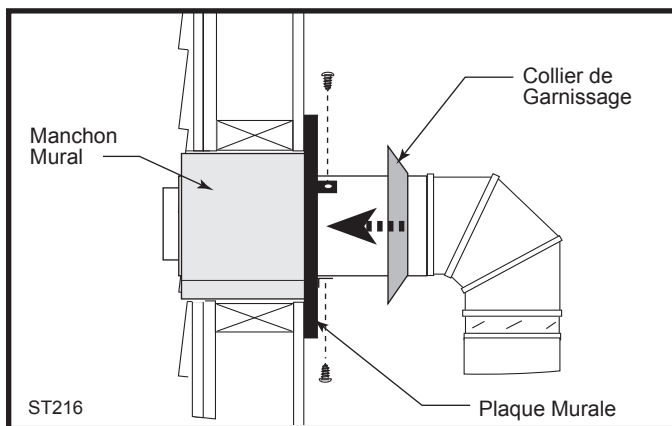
Installez le conduit horizontal et les pièces d'assemblage de la plaque murale.
